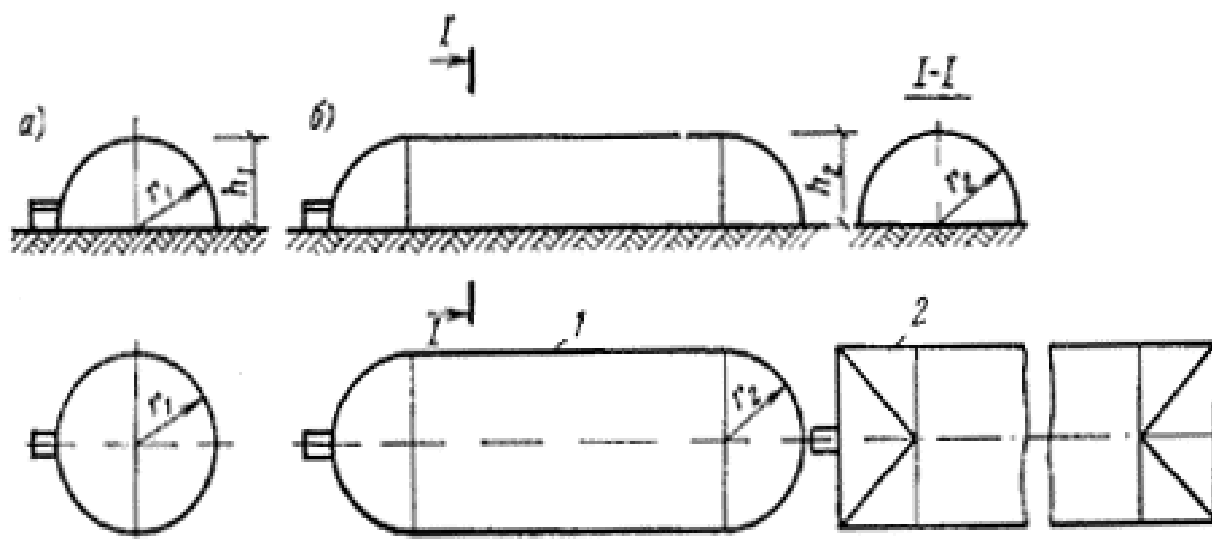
Схемы воздухоопорных конструкций: а — сферическая; б — цилиндрическая; 1 — план оболочки со сферическими торцами; 2 — то же, с цилиндрическими торцами
